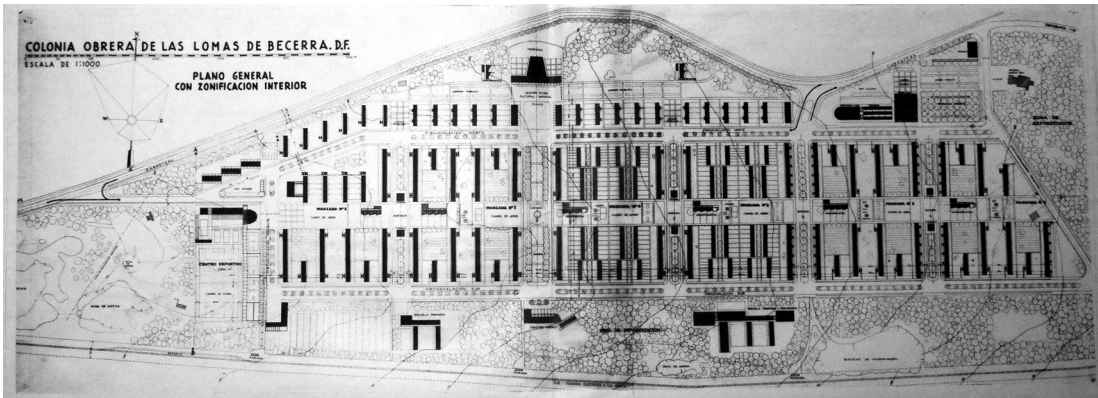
Plano de conjunto. Fuente Stiftung Bauhaus Dessau, I1812D
